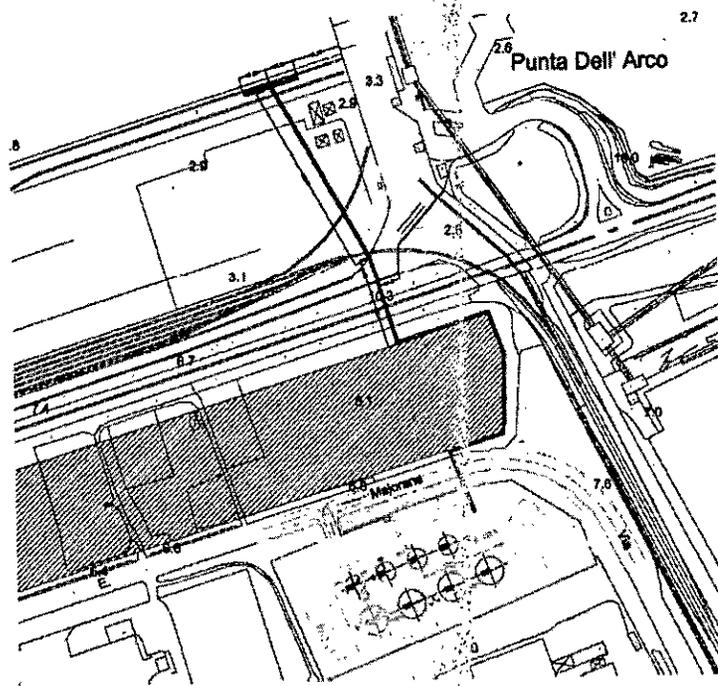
TRACCIATO TERMINALE DI PROGETTO
